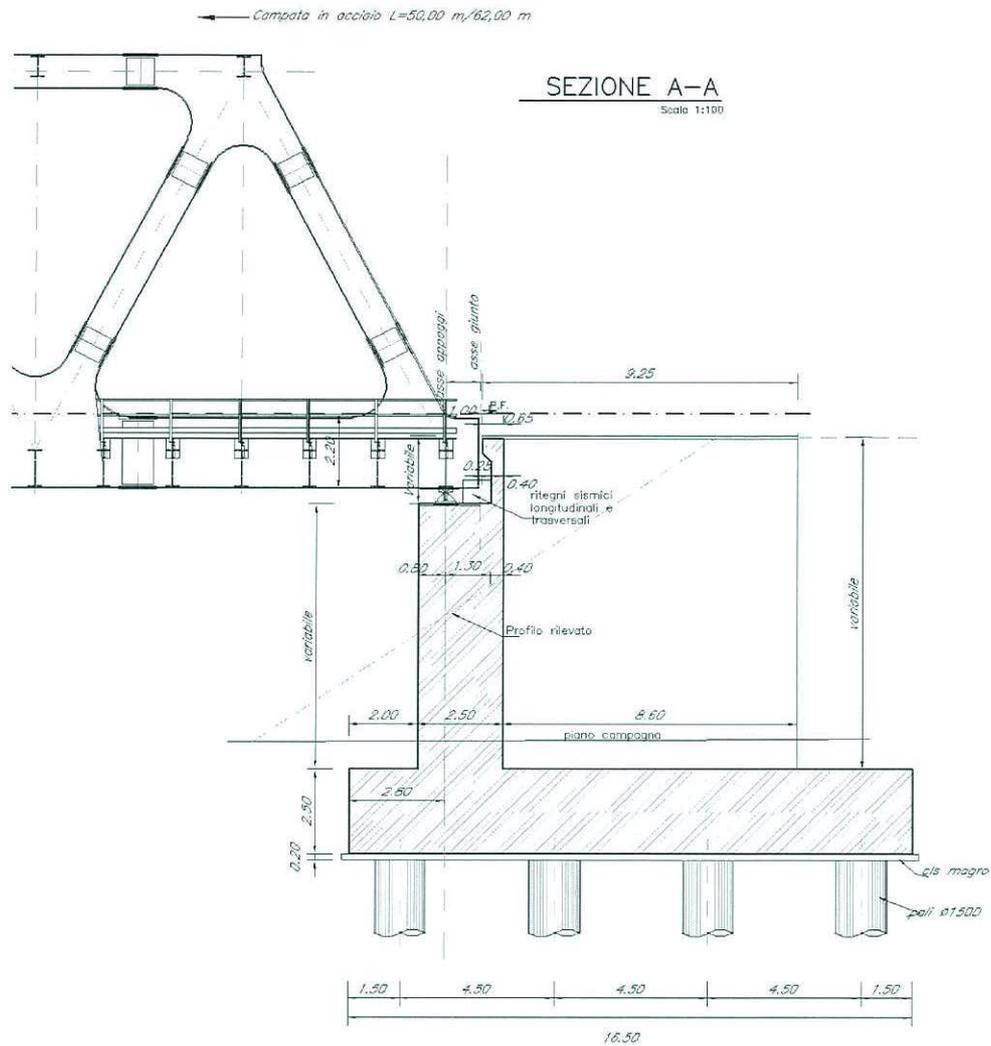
Sezione longitudinale della spalla tipo.
